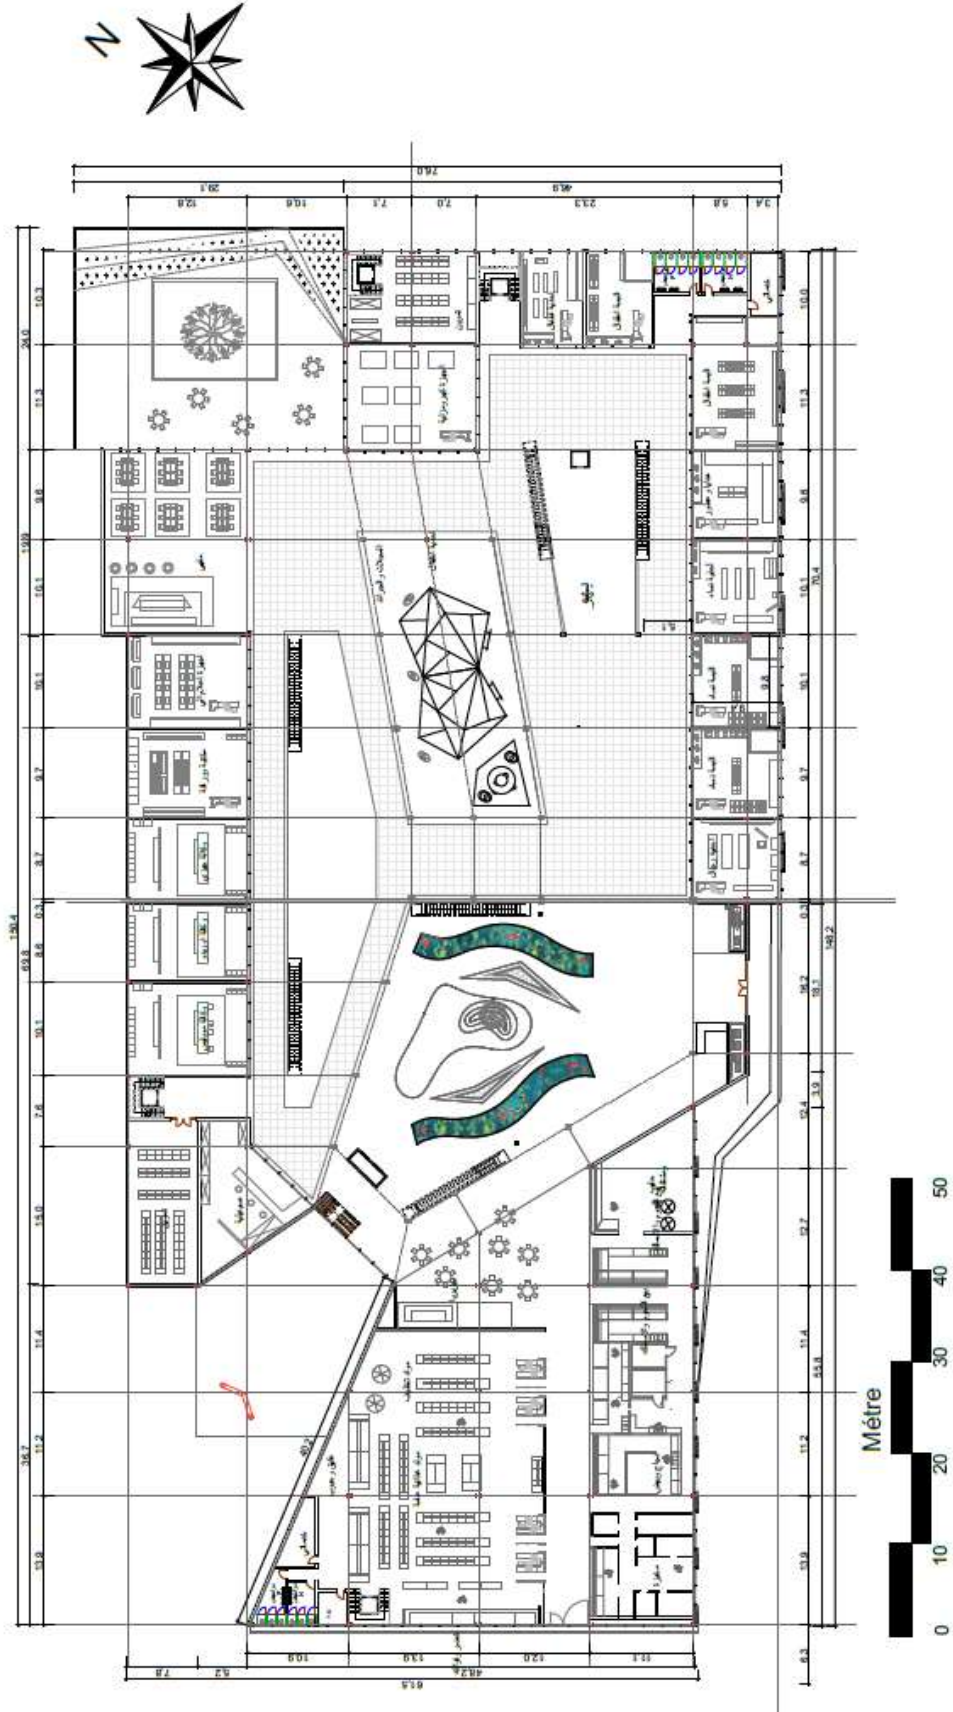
مخطط الطابق التحت الأرضي -2-
